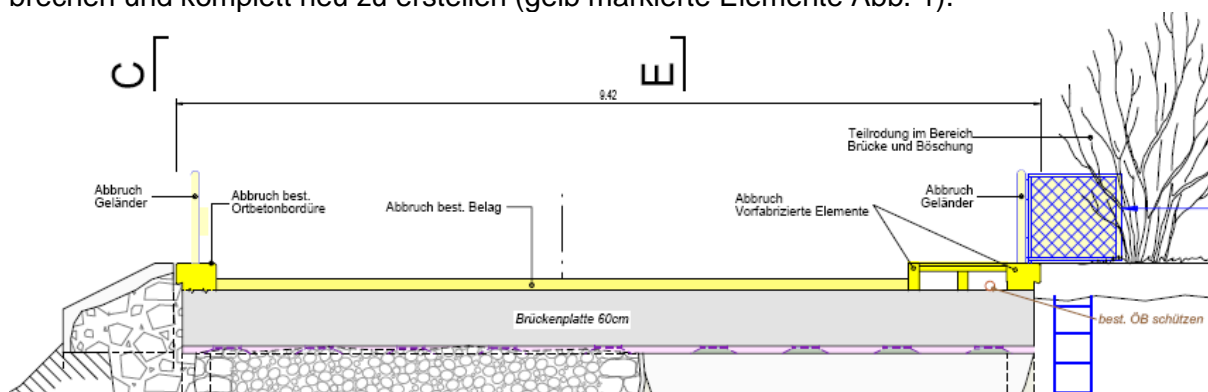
Querschnitt A-A (Abbruch des bestehenden Aufbaus)
